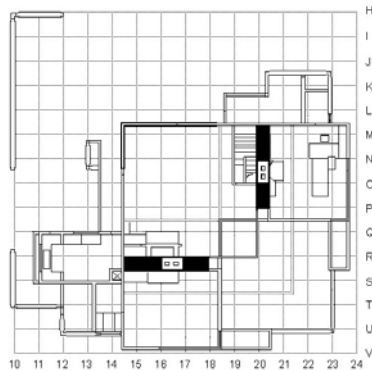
하우주택 (The How House, 1925)의 평면도 및 분석도
